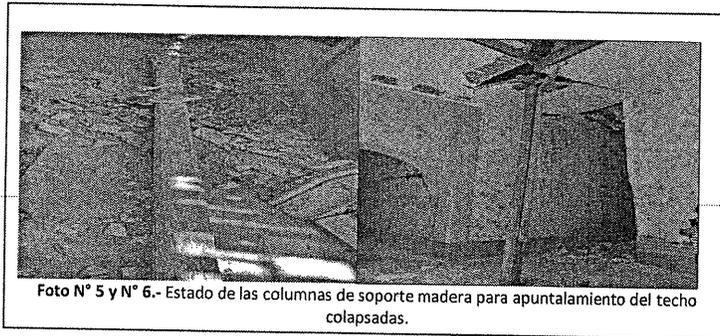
y N° 6.- Estado de las columnas de soporte madera para apuntalamiento del techo colapsadas.
